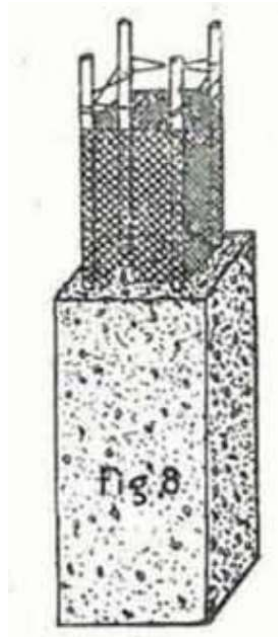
, Solución de armado para pilares del Sistema Ribera. Del libro Hormigón y cemento armado de J.E.Ribera (1902).
